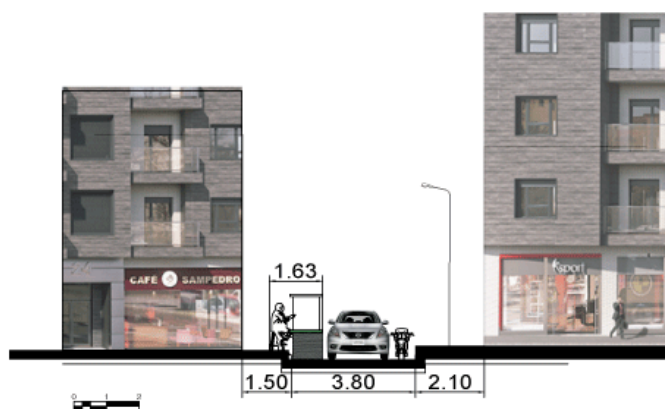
05 Perfil 01 Calle 8 Fuente: Propia
